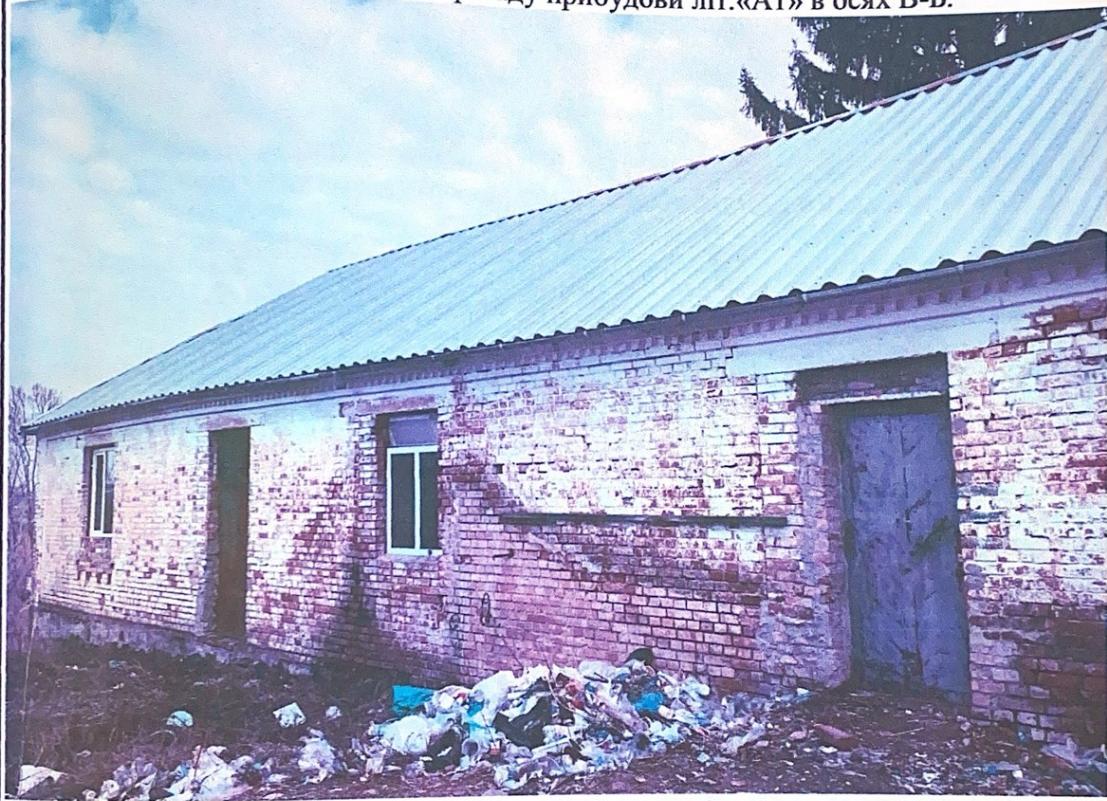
Фрагмент фасаду прибудови літ.«А1» в осях Е-Б.
